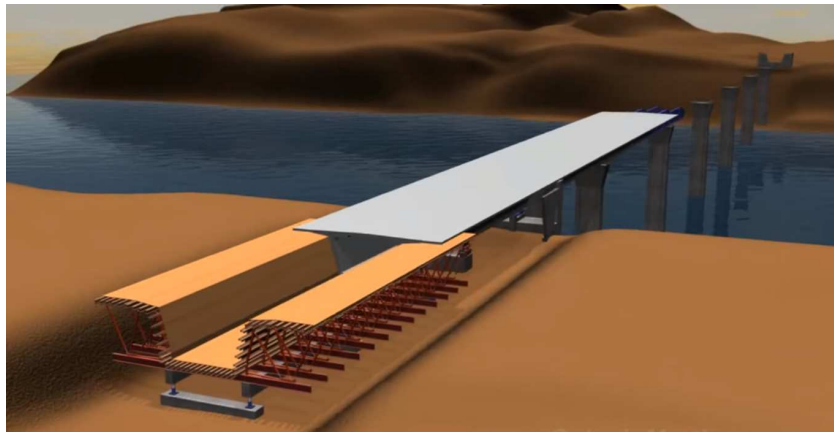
Sistema constructivo empujado. Imagen extraída de [www.octaviomartins.com](http://www.octaviomartins.com)
